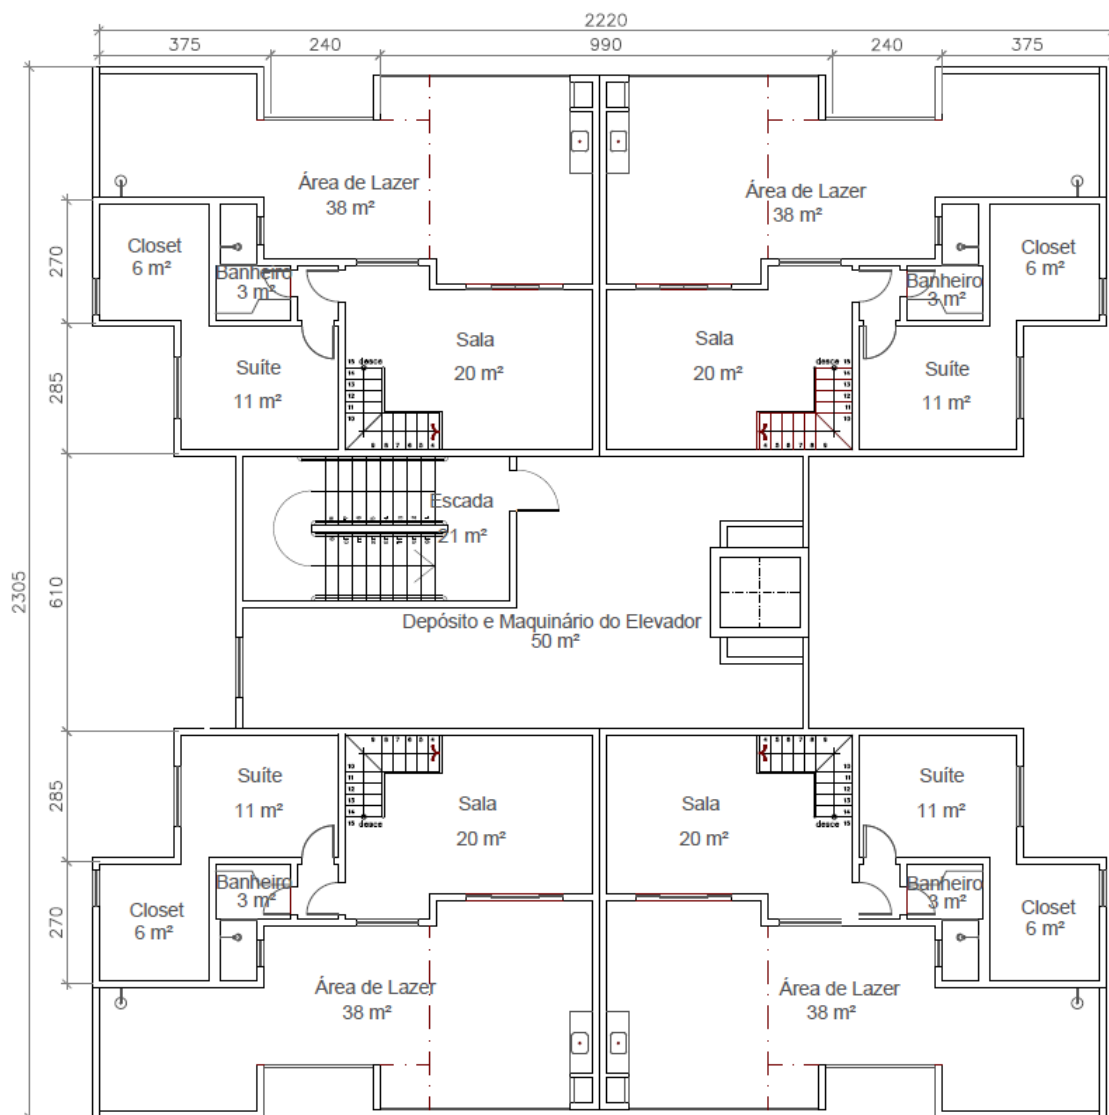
Projeto arquitetônico do segundo pavimento do apartamento de cobertura da edificação
